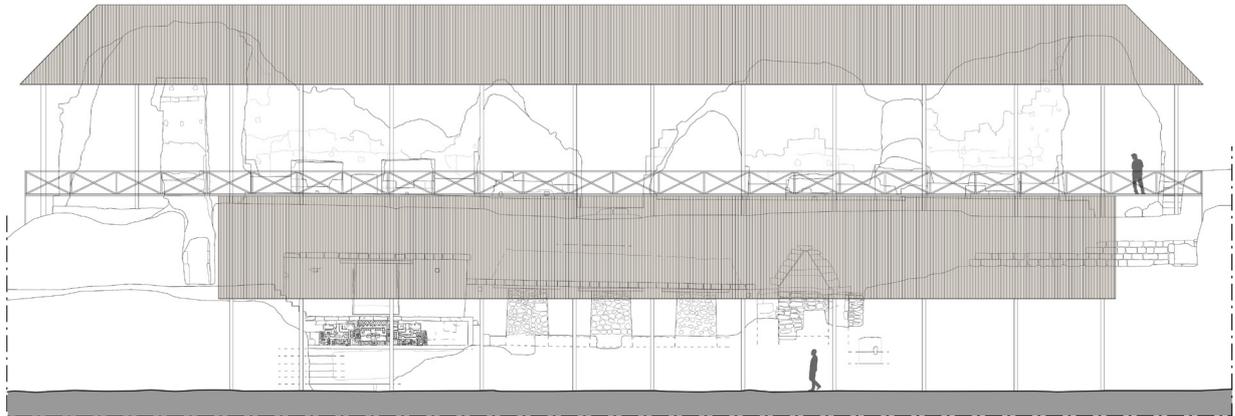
Alzado de la Acrópolis con la cubierta vegetal.
